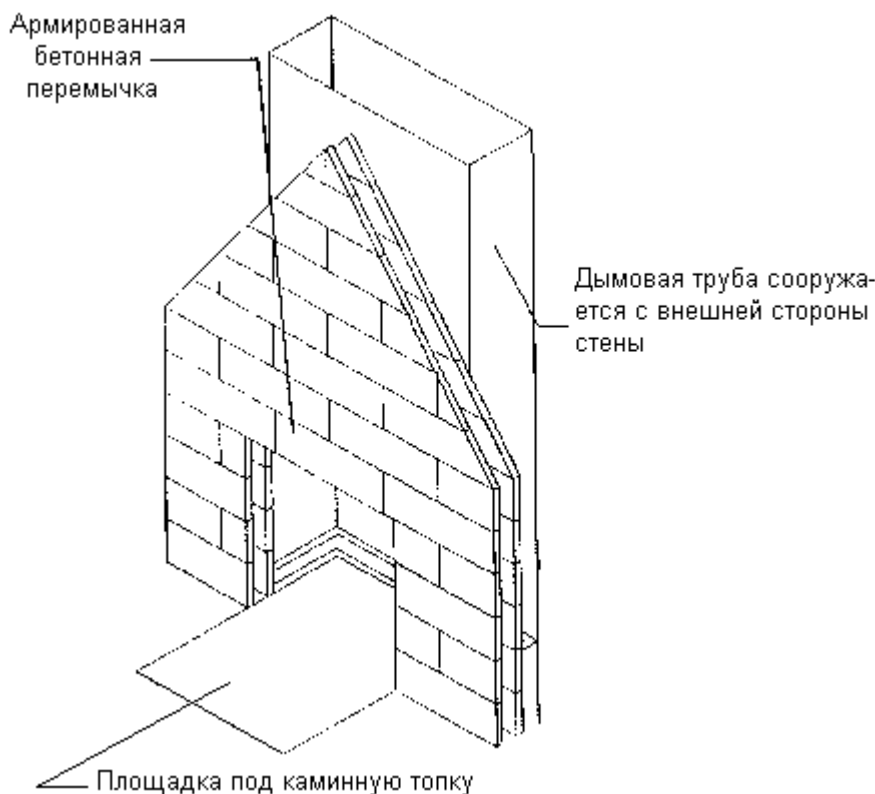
Стандартный проем для устройства камина и дымовой трубы
